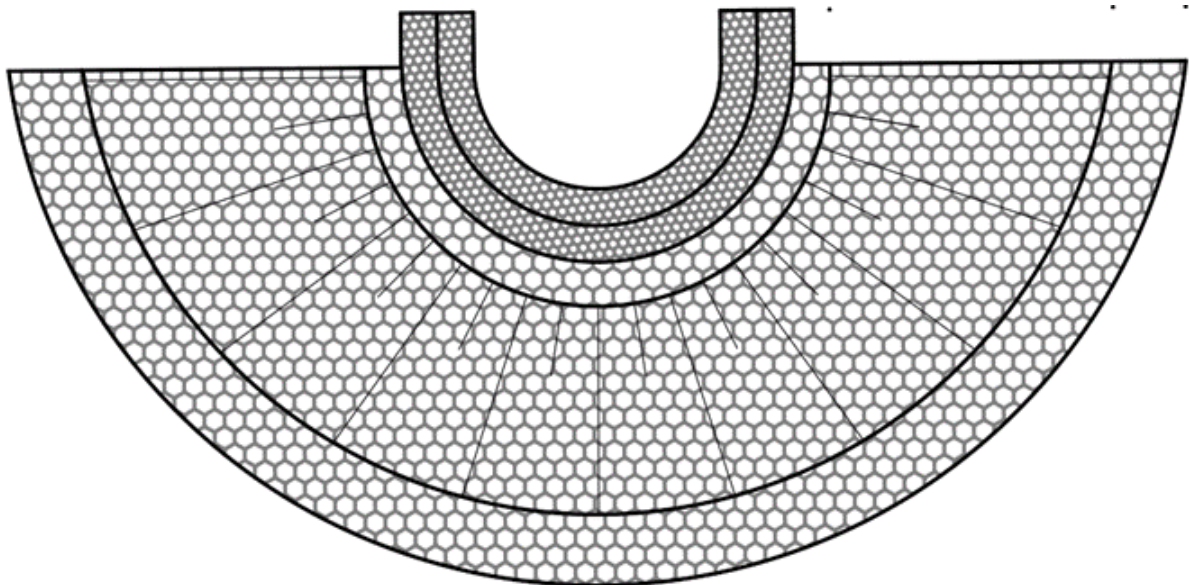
Arranjo em planta do vertedor proposto - sem escala.
